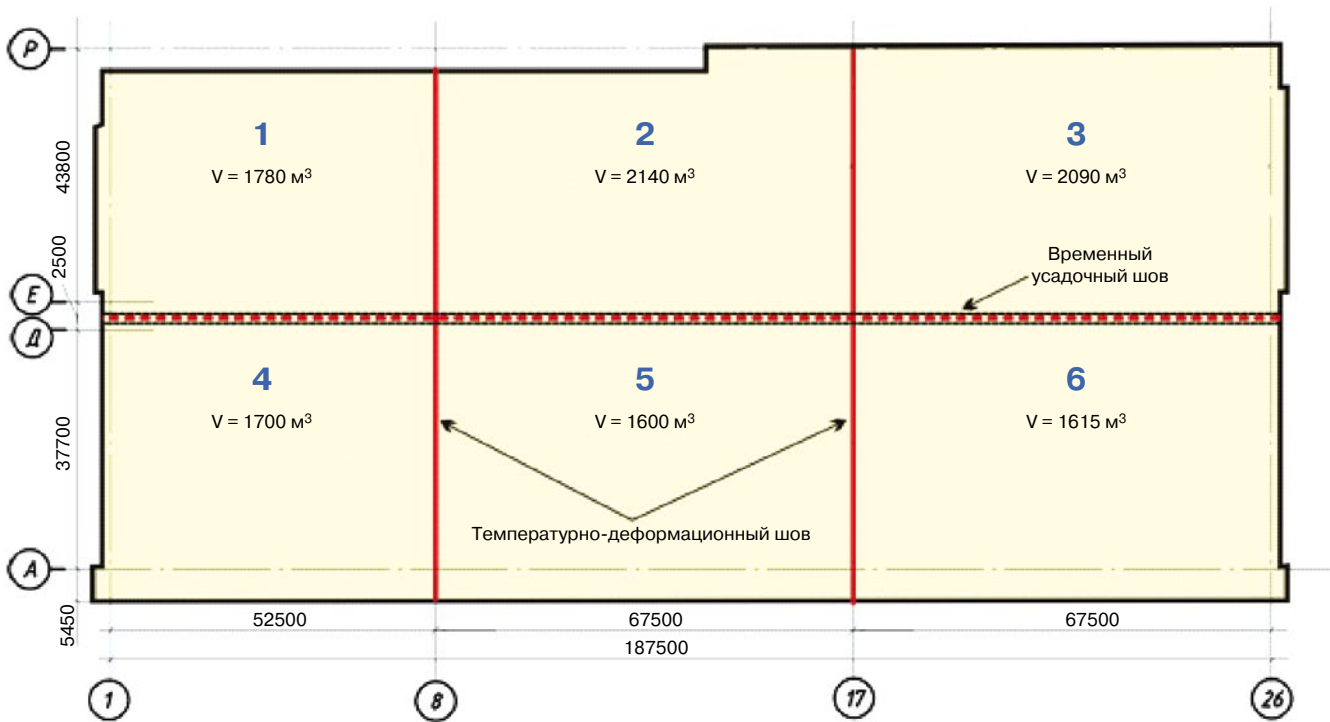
Разбивка фундаментной плиты на блоки бетонирования
